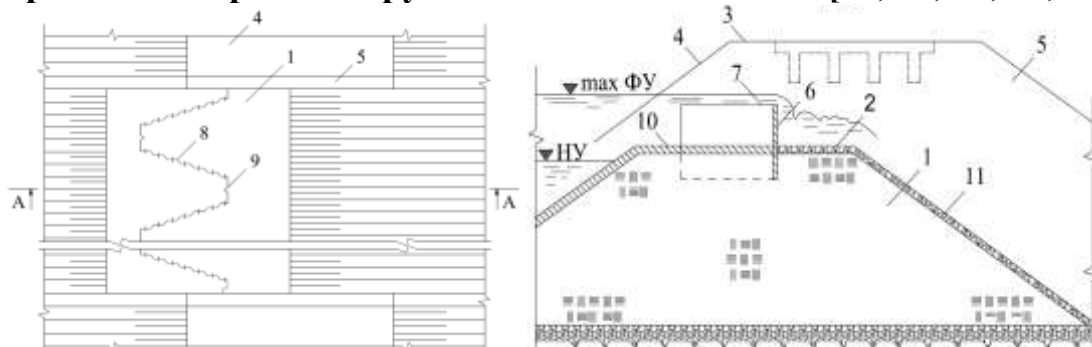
С размываемой вставкой и лабиринтной стенкой: 1 – размываемая вставка; 2 – отметка гребня плотины; 3 – отметка гребня подпорного сооружения; 4 – подпорное сооружение; 5 – устой; 6 – водосливная стенка; 7 – отметка гребня водосливной стенки; 8 – стальные шпунты зетового профиля; 9 – стальные шпунты корытного профиля; 10 – защитный слой из бетона; 11 – защитный слой из песчано-гравийного материала
